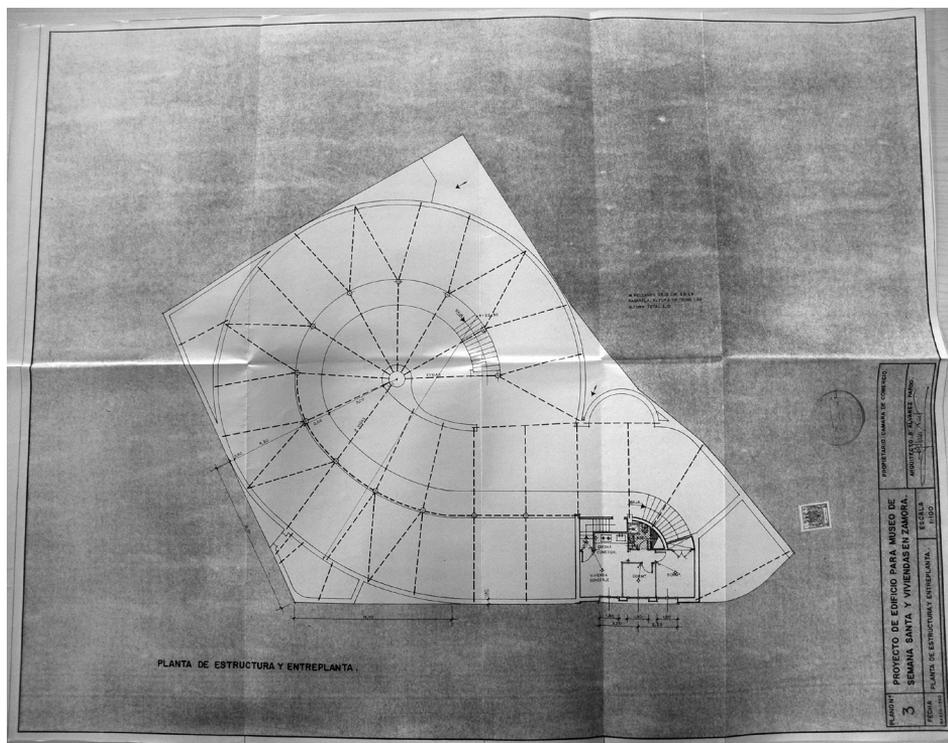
Plano 3, planta de estructura y entreplanta del museo de Semana Santa. Salvador Álvarez Pardo, 1960.
